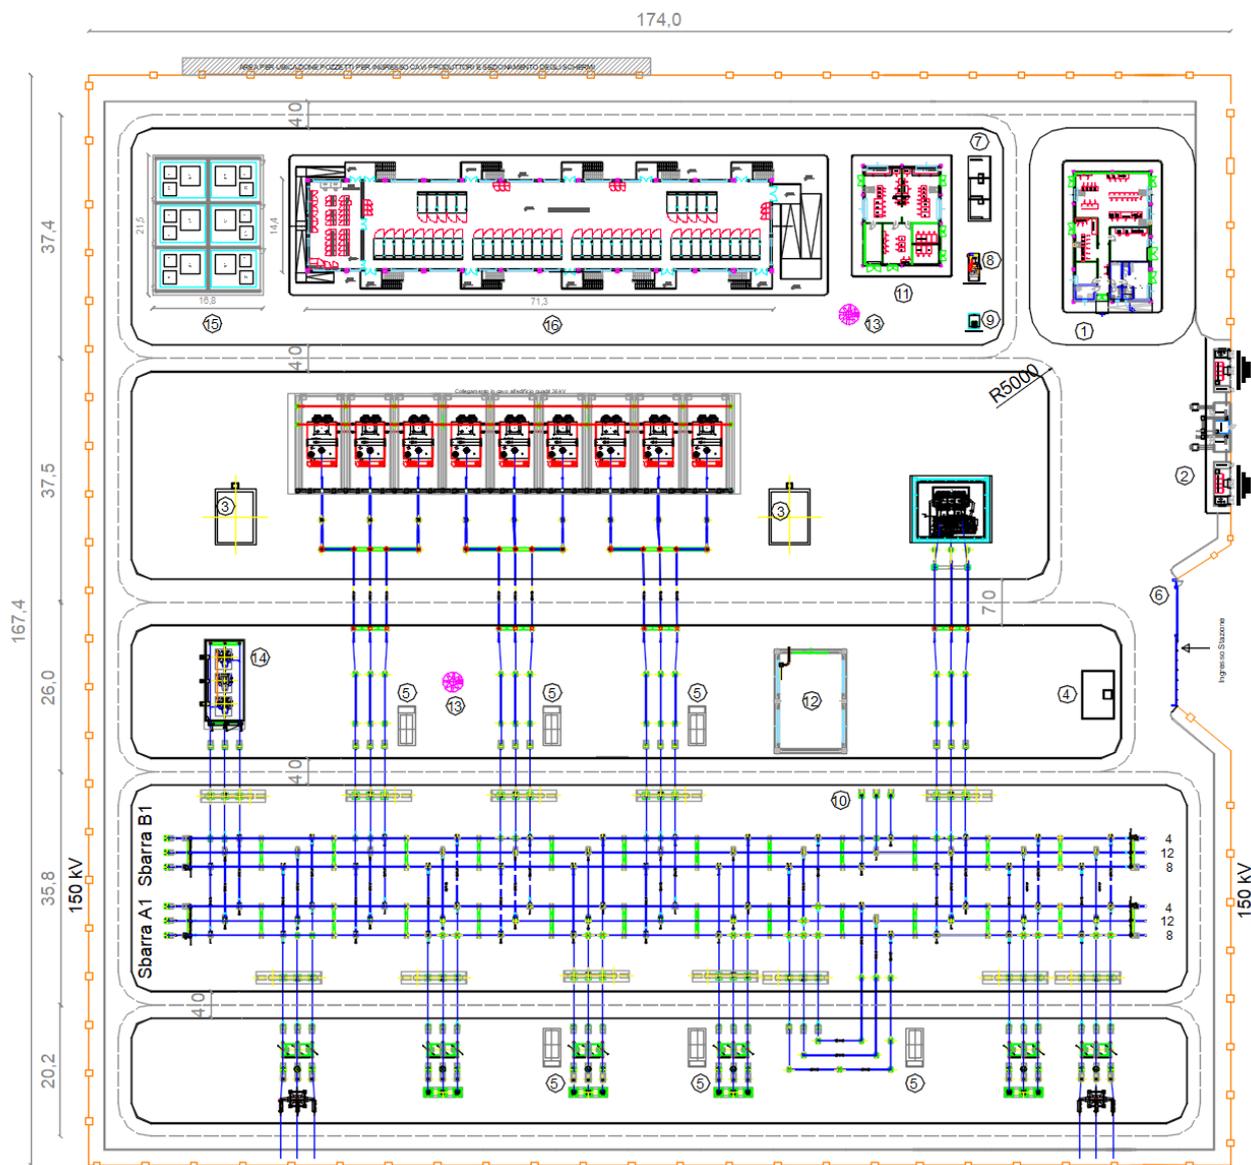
Planimetria elettromeccanica futura SE RTN 150/36 kV "Selegas 2"
